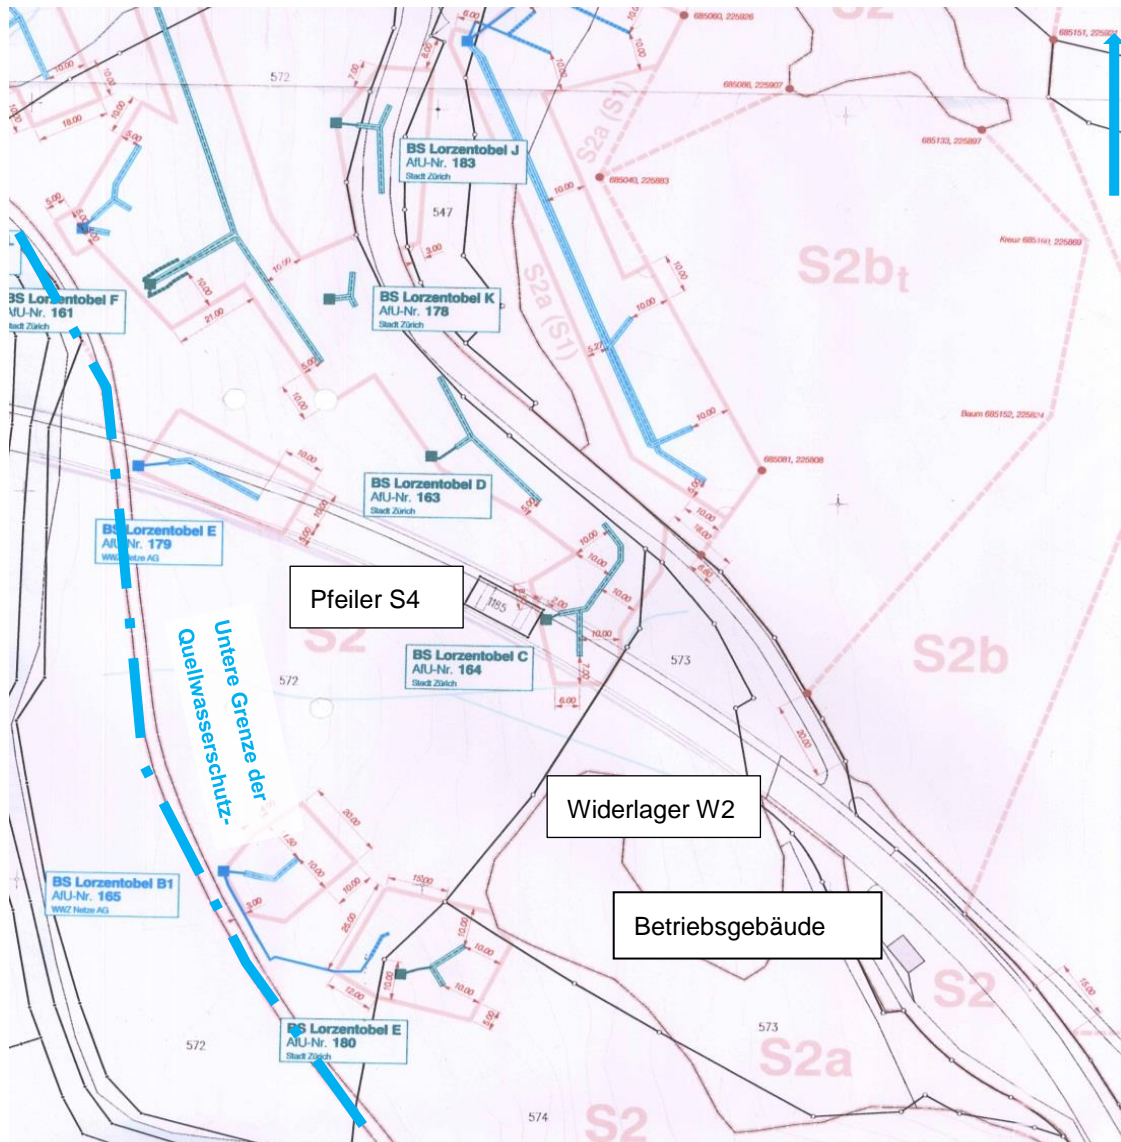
Auszug aus dem Plan zu den Grundwasserschutzzonen und den Wasserfassungen
